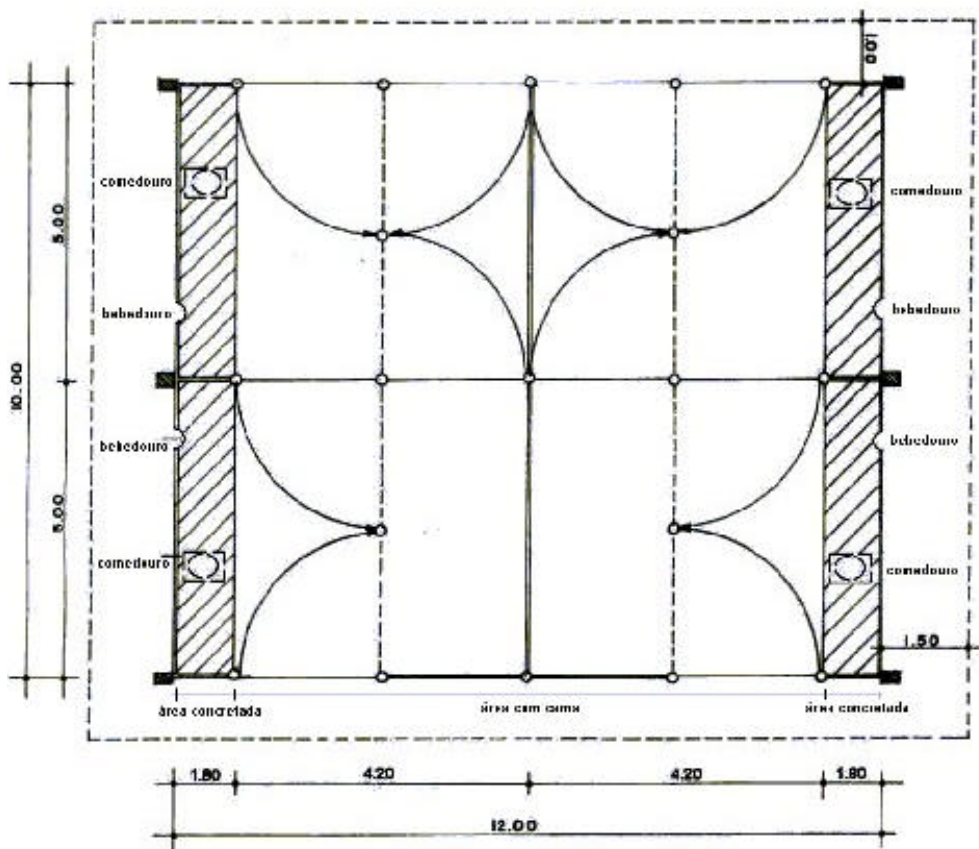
Planta baixa da instalação com sistema de cama sobreposta
